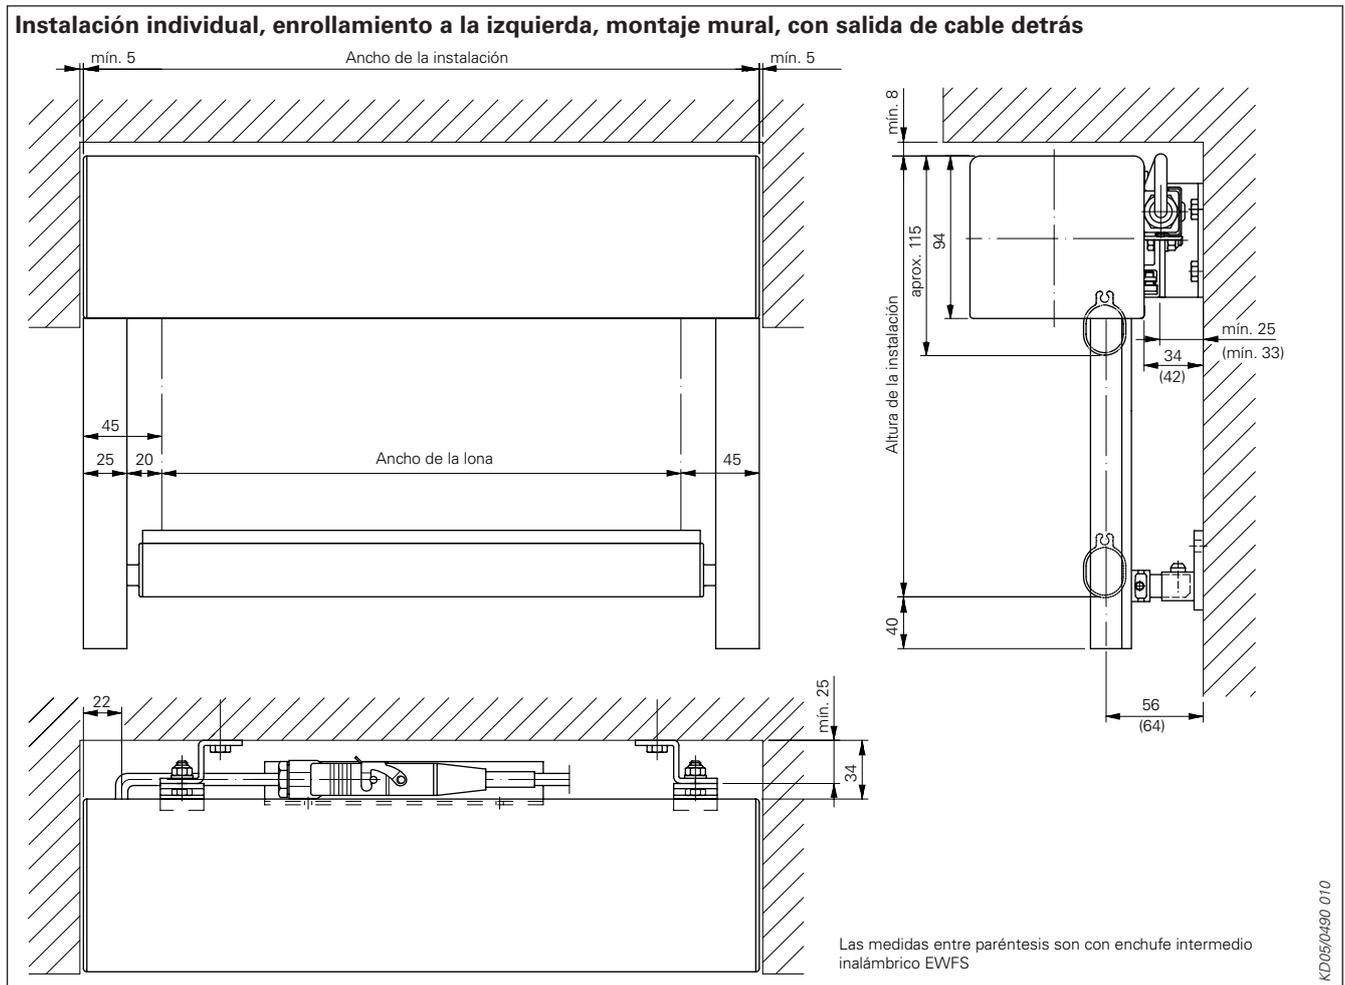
Instalación individual, enrollamiento a la izquierda, montaje mural, con salida de cable detrás
